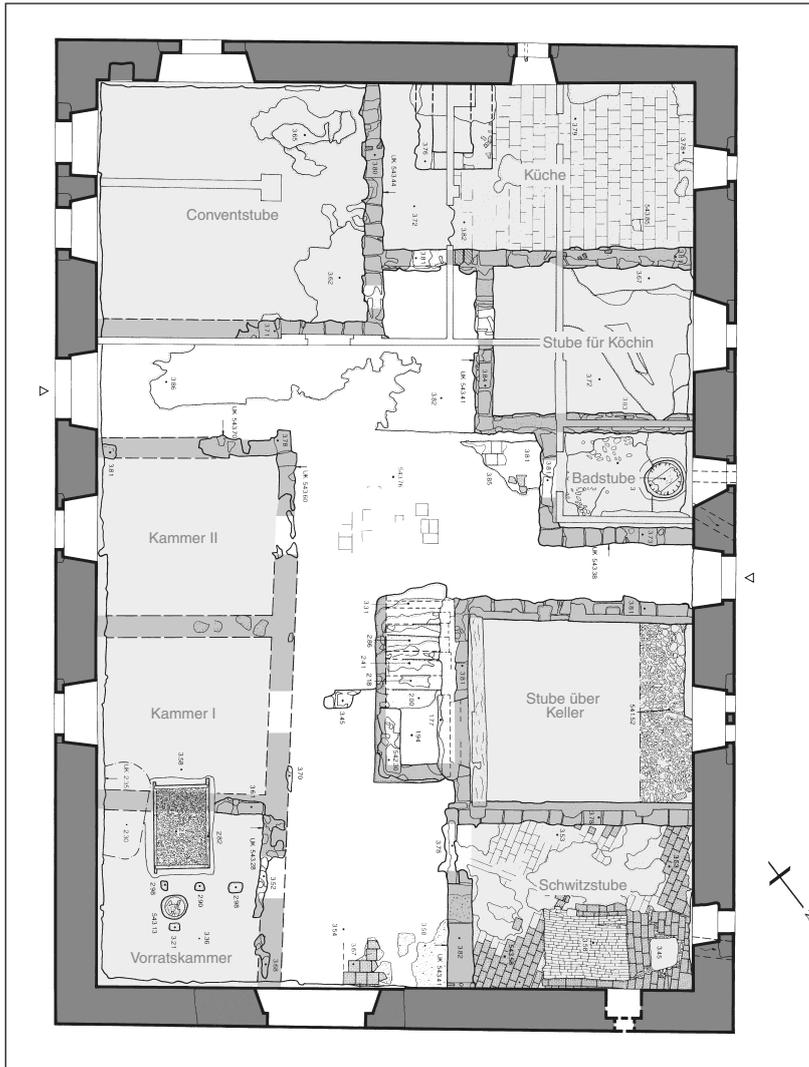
(oben): Burgdorf, Siechenhaus. Grundriss des Erdgeschosses mit den ergrabenen Befunden und der erschließbaren Raum- und Funktions-einteilung.
